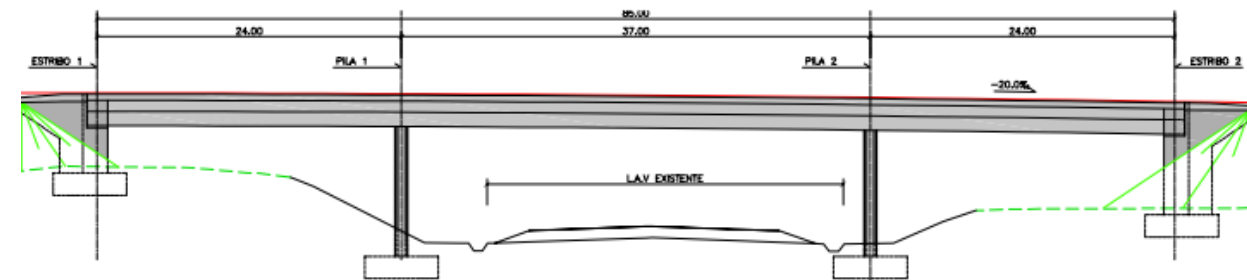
ALZADO VIADUCTO SOBRE PLATAFORMA LAV P.K 3+240
